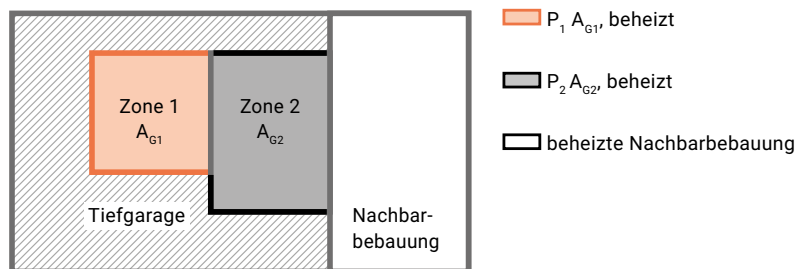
Grundrisse UG: erdberührte Bodenplatte einer Tiefgarage mit beheizter Nachbarbebauung
